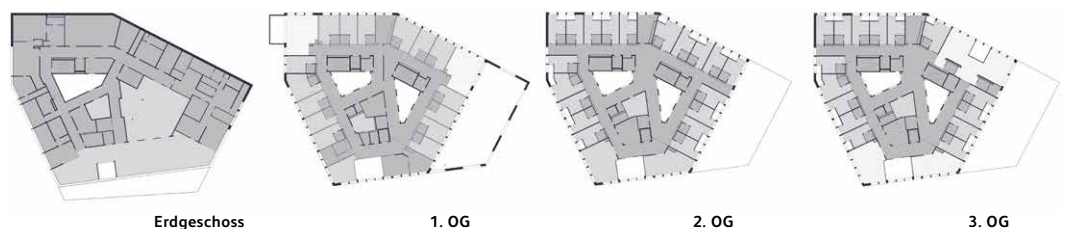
Grundrisse [Licht@hslu, Grundlage Bob Gysin & Partner]
